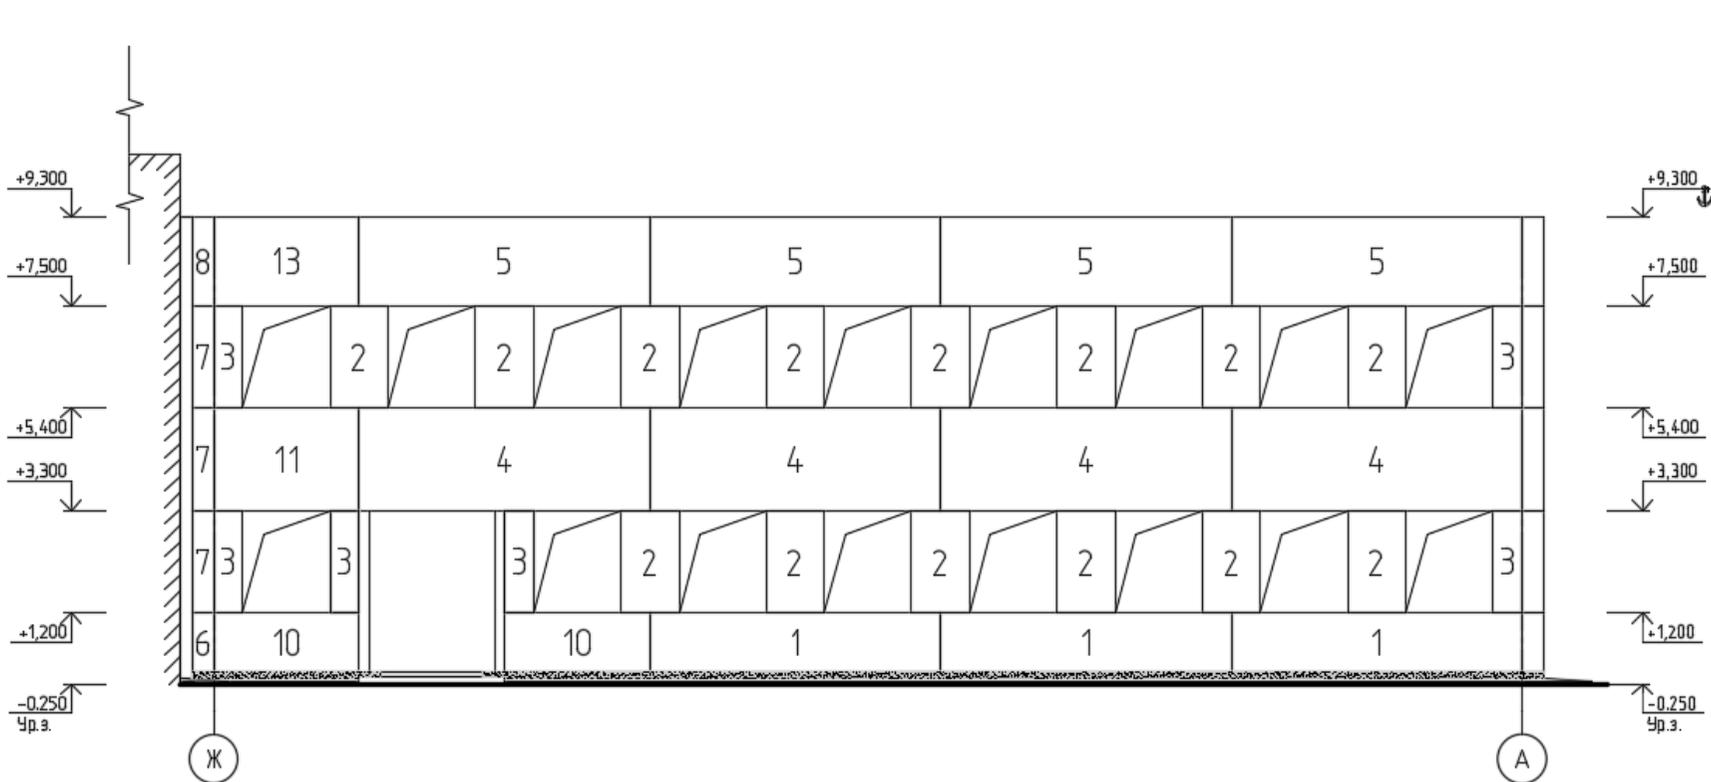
Схема расположения стеновых панелей на фасаде Ж-А
